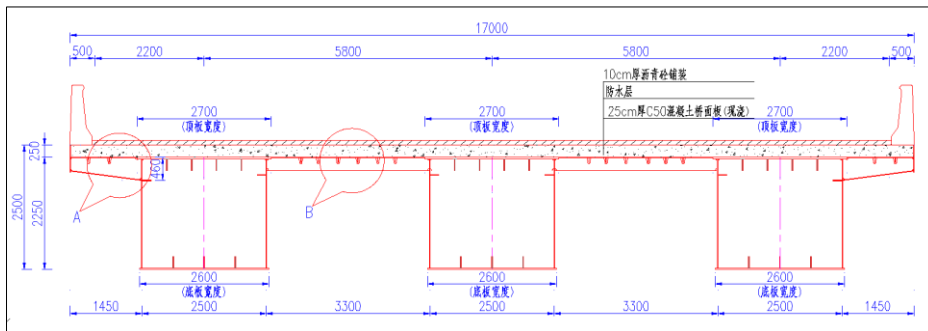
方案一横断面图（闭口钢箱梁+现浇混凝土桥面板）
